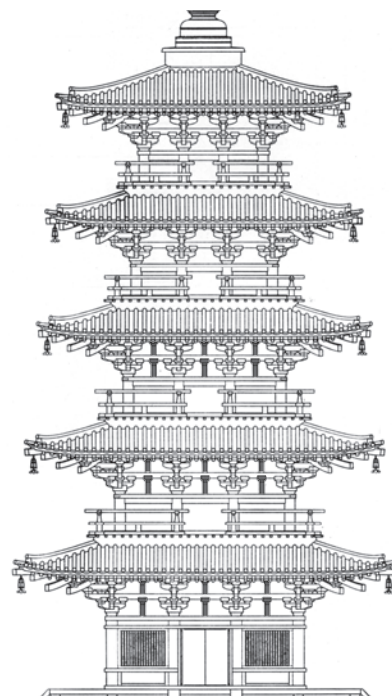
元興寺極楽坊五重小塔 塔身立面図 1 : 40
